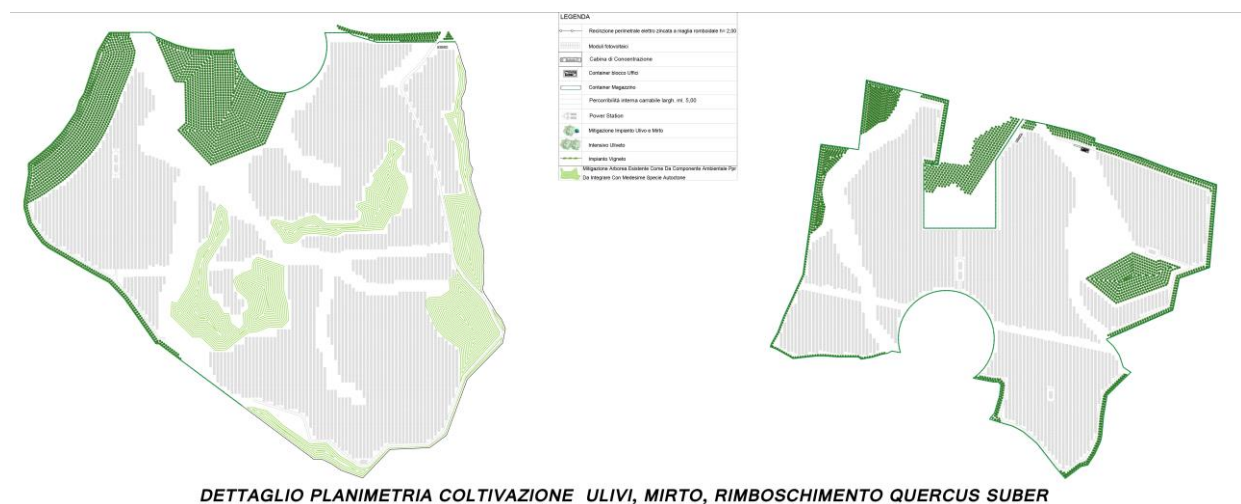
Planimetria Impianto AGRO-FVT perimetrazione e parti intensive
